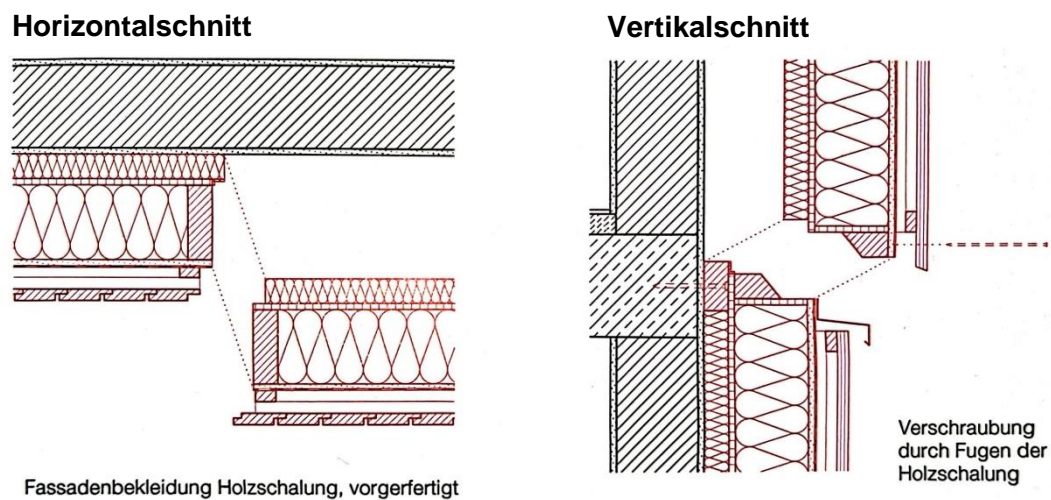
Konstruktionsaufbau und Montage eines Fassadenelements; (Krötsch et al., 2024)
